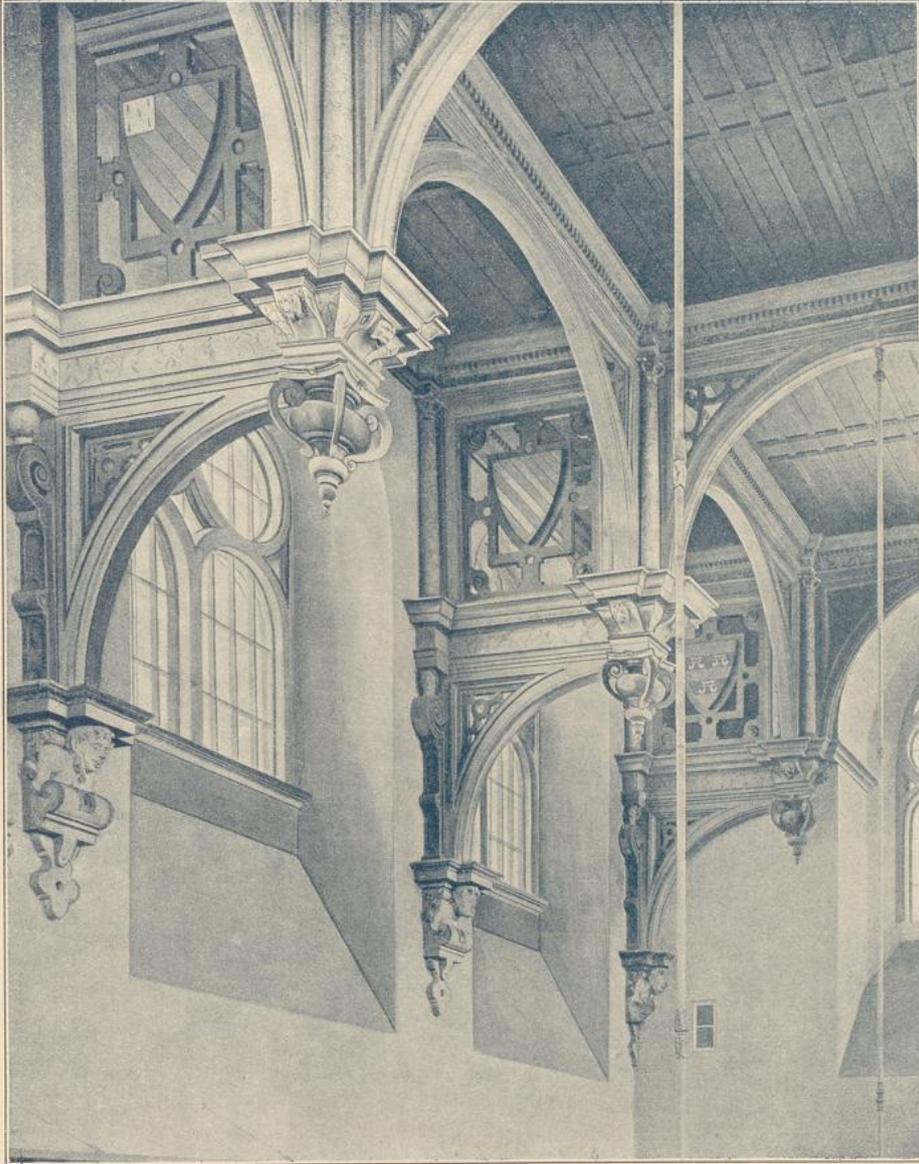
Deckenkonstruktion der Halle in Wollaton Castle. Elisabethstil Ende XVI. Jahrh. Uhde, Grossbritannien.
